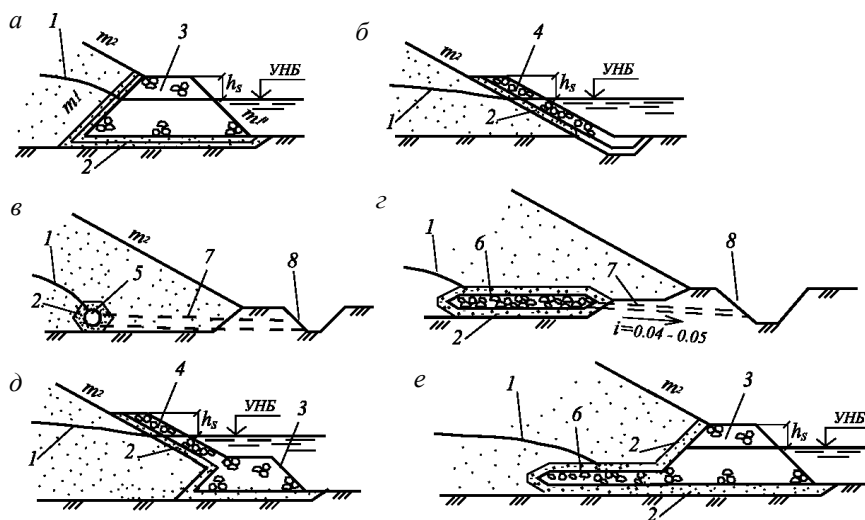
Основные типы дренажей грунтовых плотин:
